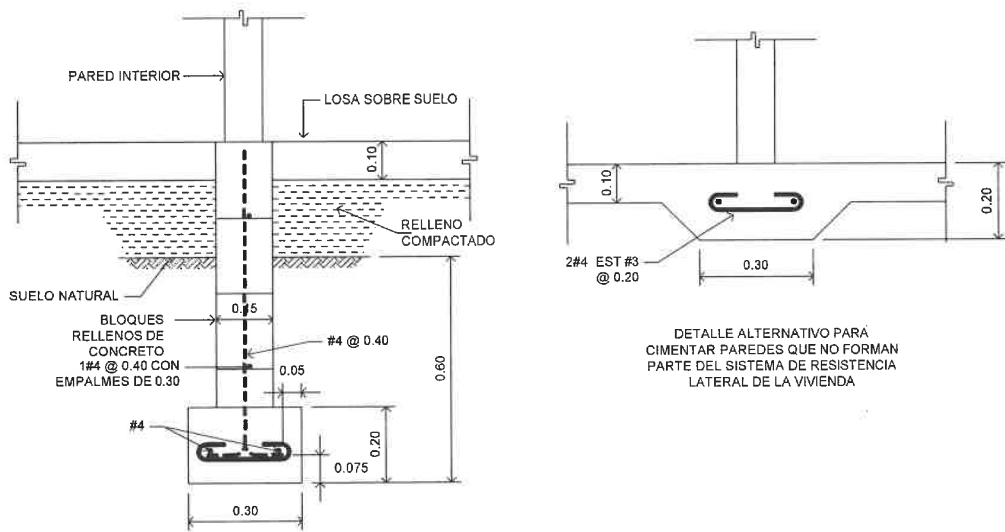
Secciones transversales de cimientos de paredes interiores
